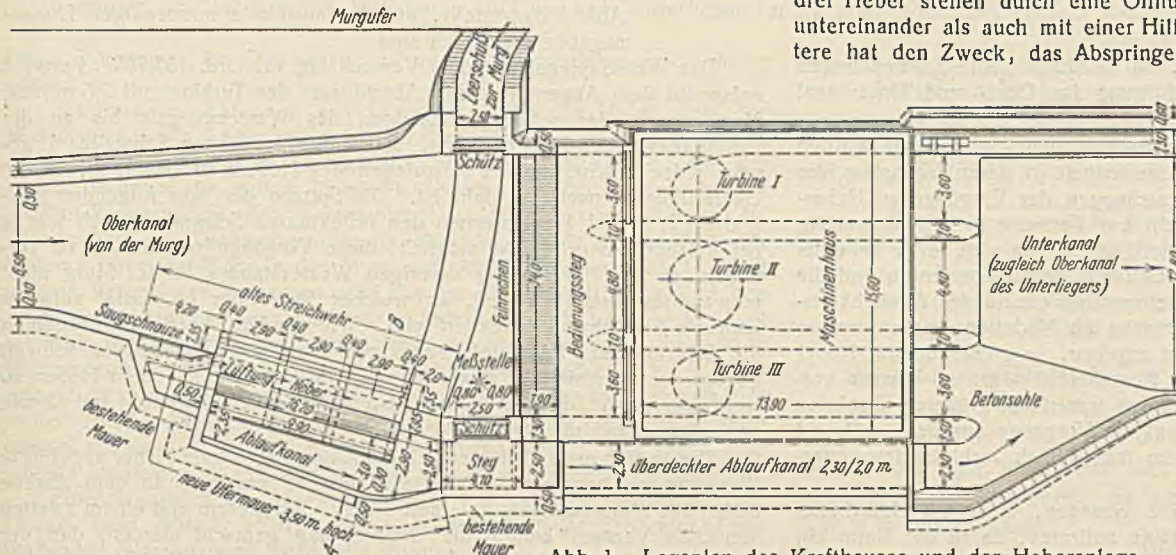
Lageplan des Krafthauses und der Heberanlage.
